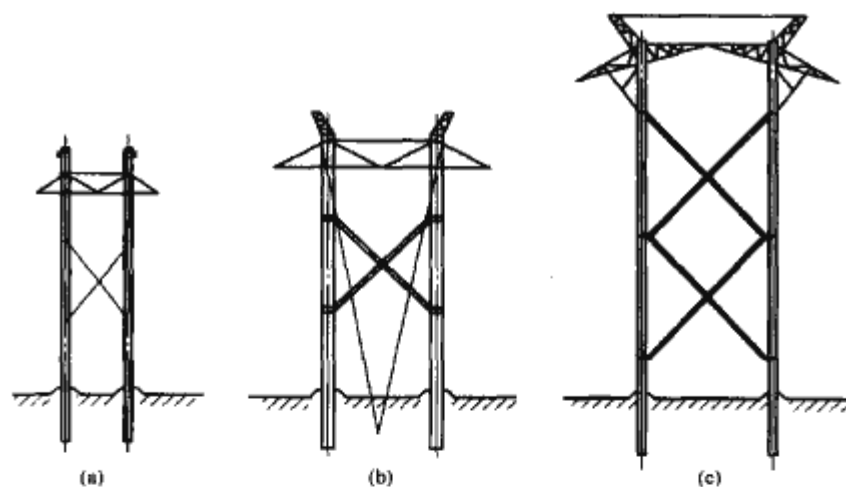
带叉梁的钢筋混凝土直线双杆
